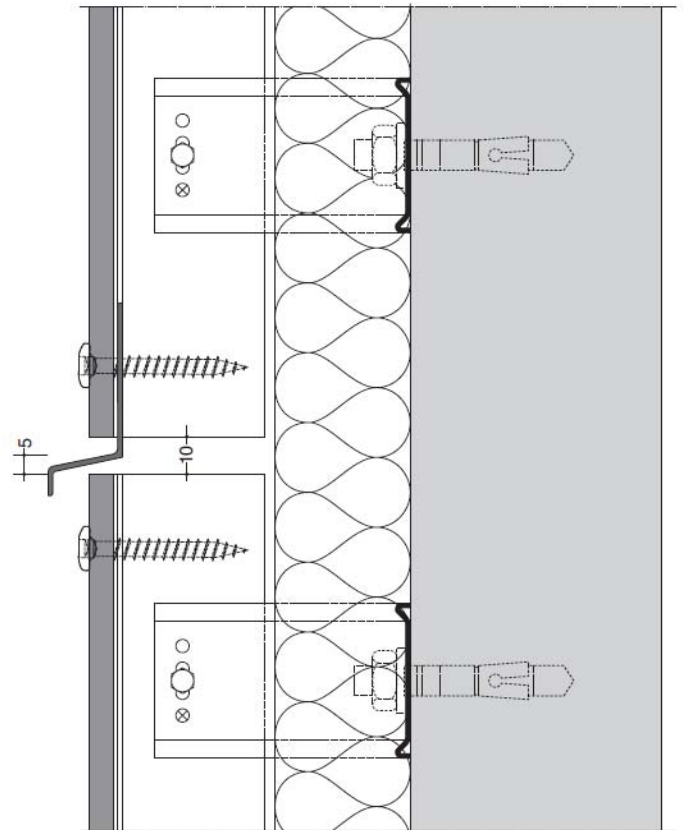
Coupe horizontale sur appui intermédiaire
